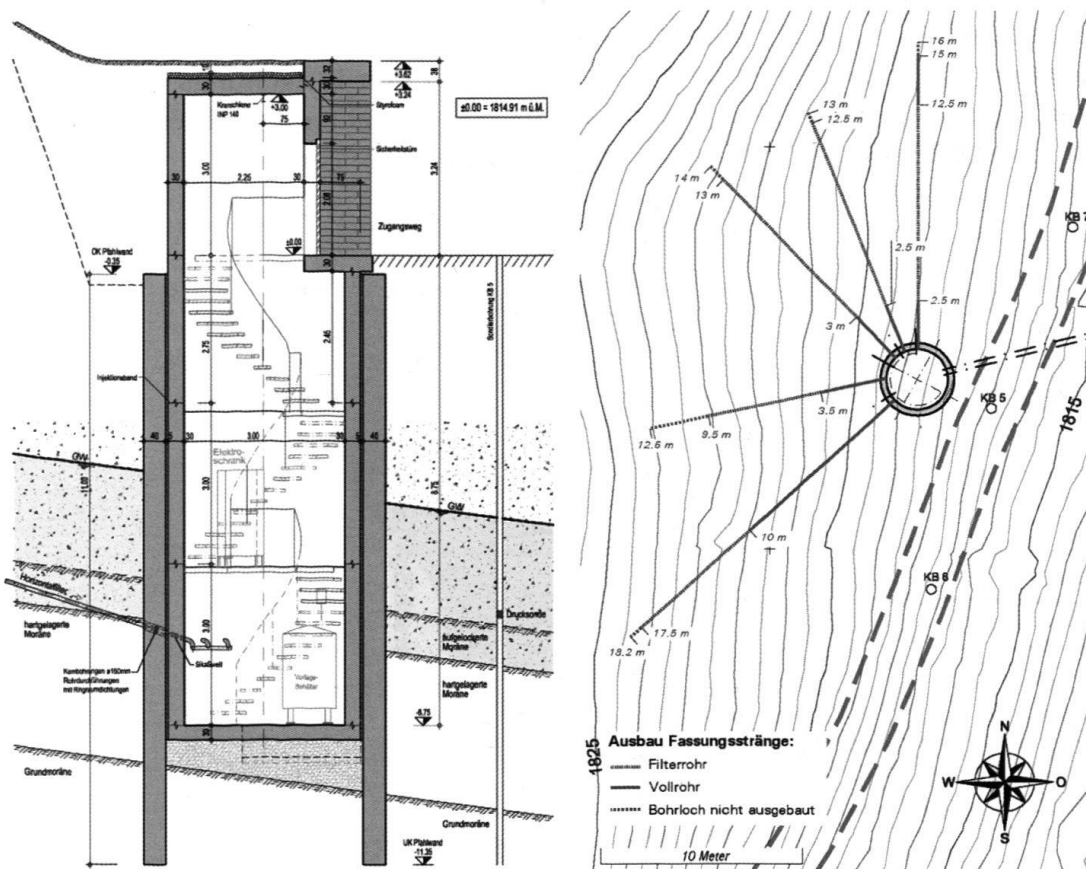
Querschnitt durch den Fassungschacht im Hangfallen (Plan: Straub AG, Chur) und Lage der Fassungsstränge.
